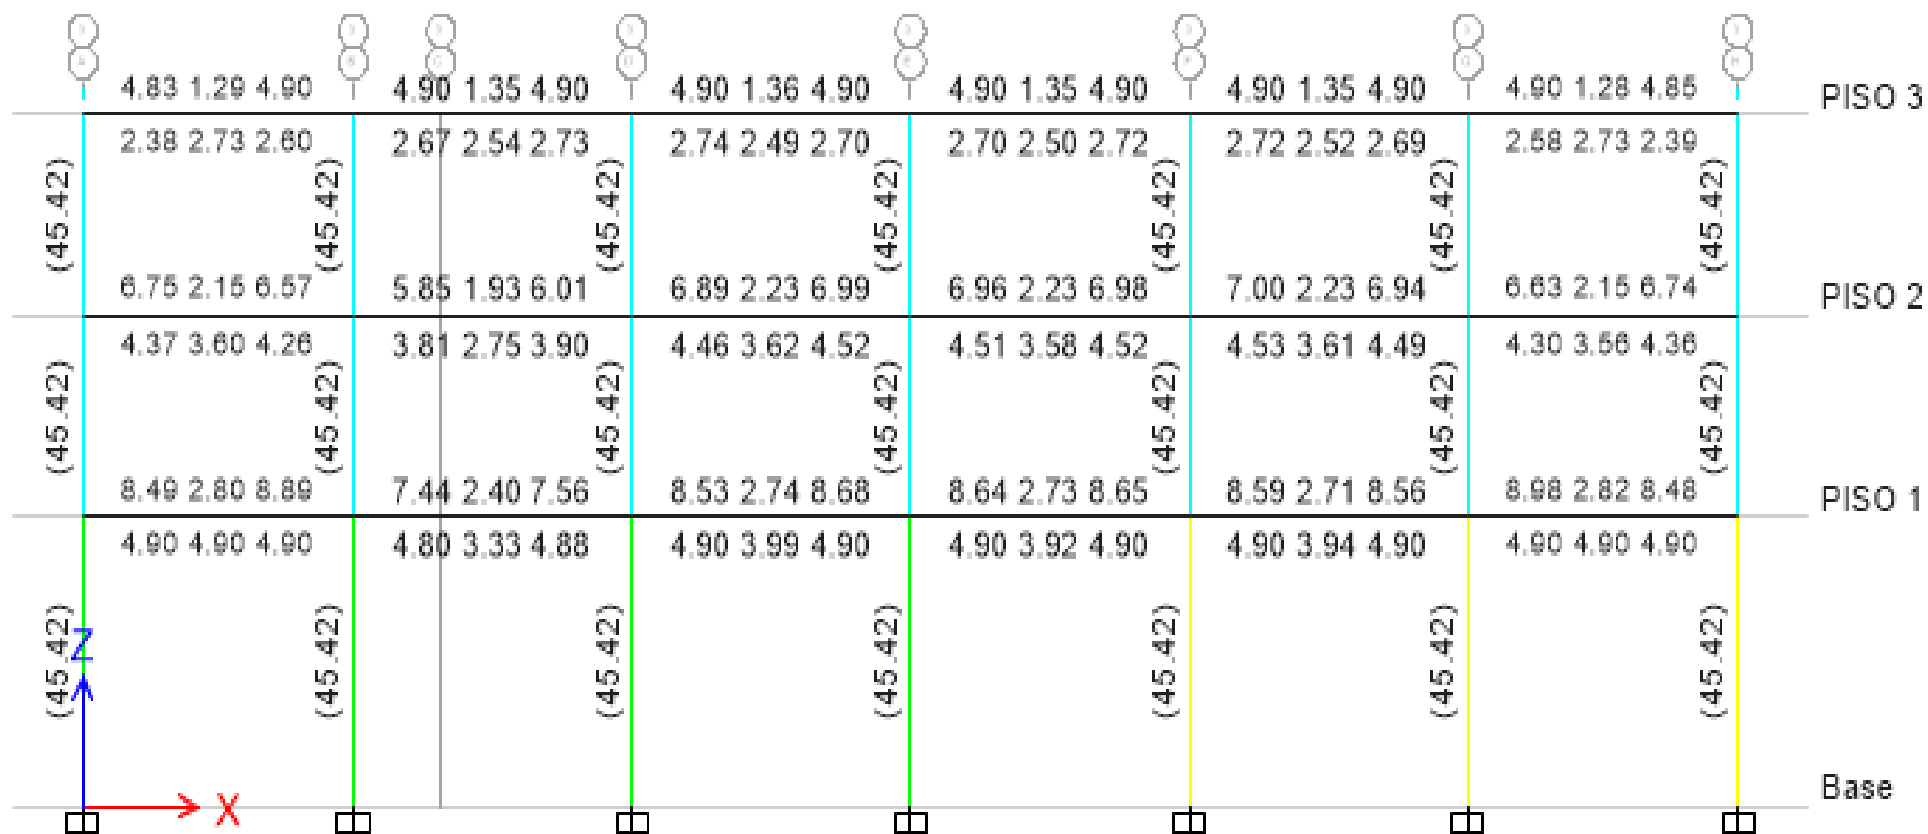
Acero de refuerzo calculado en (cm²) por el programa estructural ETABS para el sistema aporticado.
